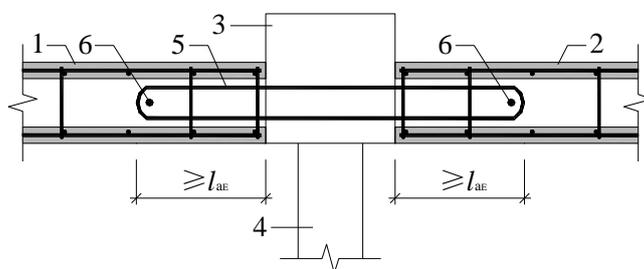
扶壁柱处剪力墙水平筋搭接构造示意
